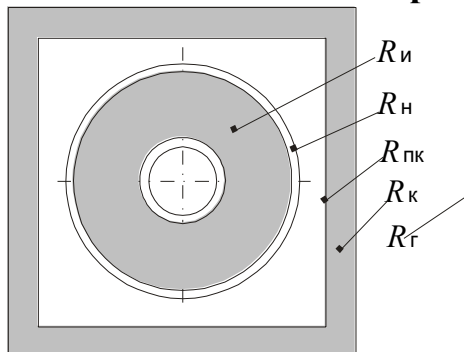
Схема канальной прокладки однотрубного теплопровода
